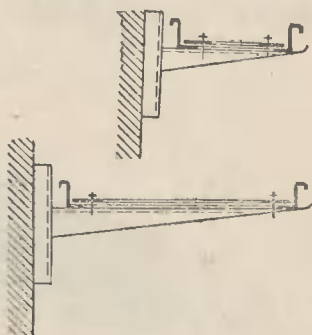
Горизонтальная установка на стене на кабельных конструкциях сварных лотков.
